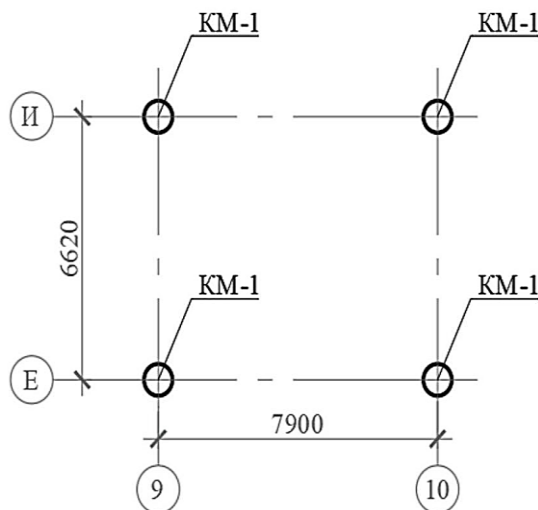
Схема розташування залізобетонних колон в осях Е-9, І-10
